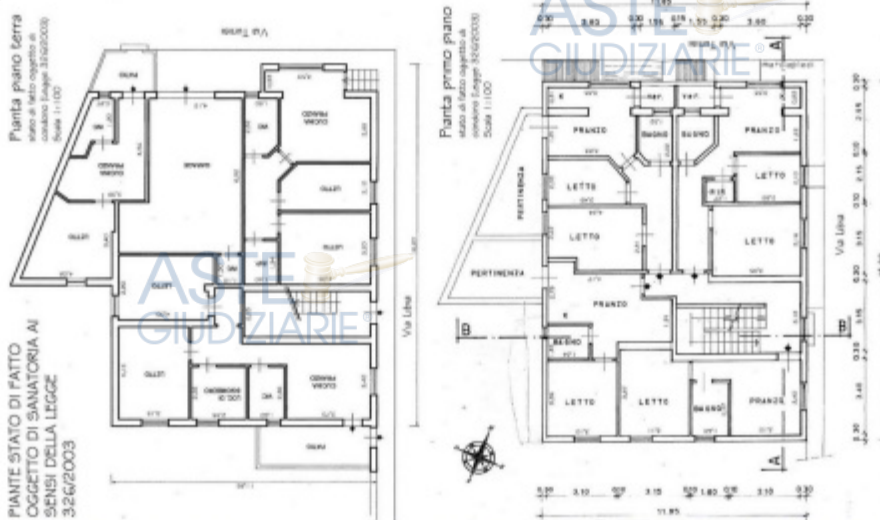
Planimetrie del piano terra e piano primo nella configurazione attuale dello stato dei luoghi di cui alla pratica edilizia di condono ex lege 326/2003.
